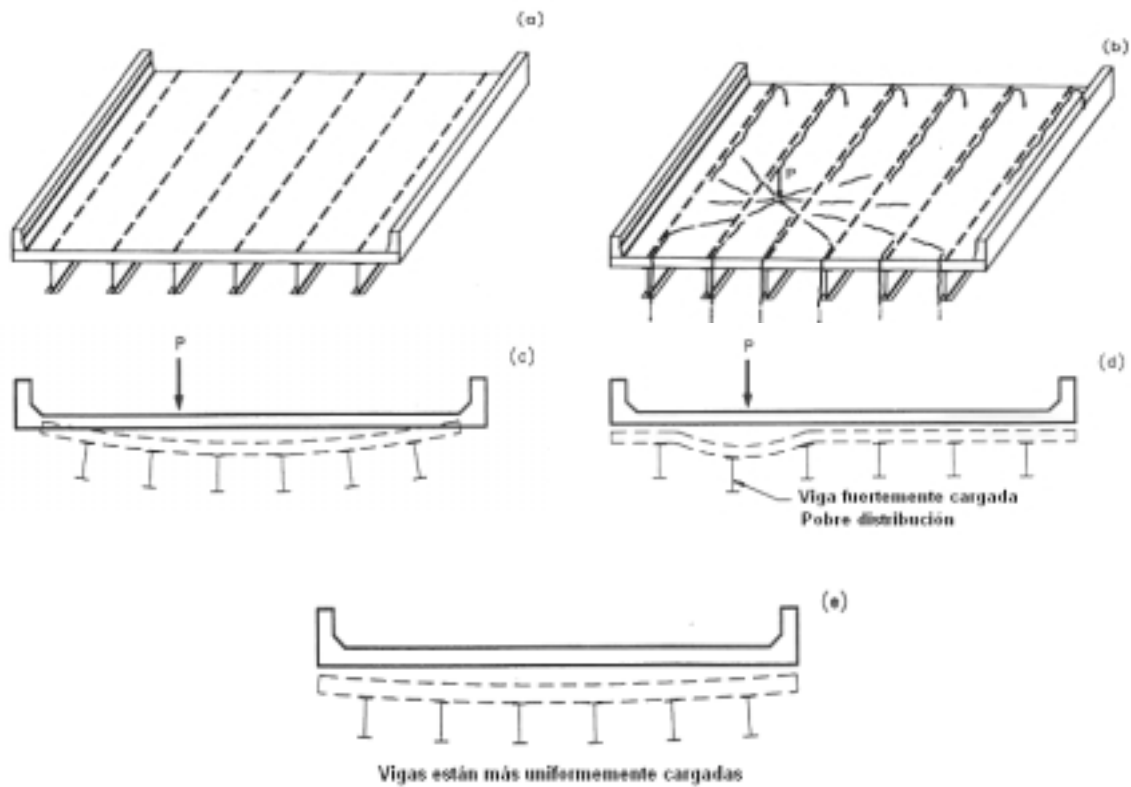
(a) Puente Losa sobre Vigas, (b) transferencia de cargas (las líneas continuas indican las acciones más grandes), (c) sección transversal deformada, (d) sección flexible transversalmente y (e) sección rígida transversalmente.
